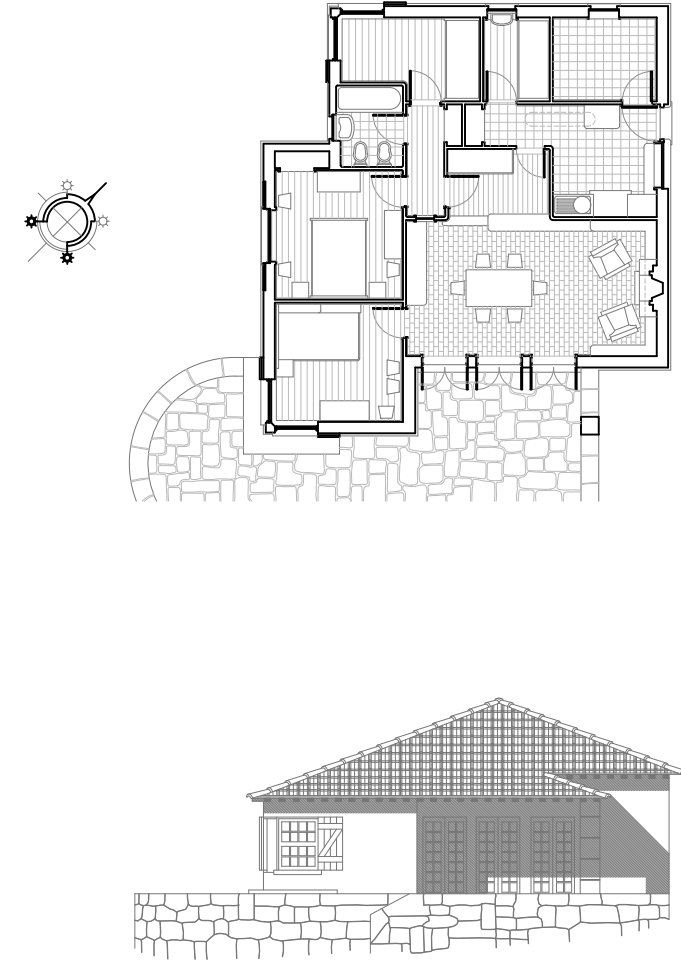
Planta e alçado sudeste da Casa Fernão Godinho - escala 1.200.
